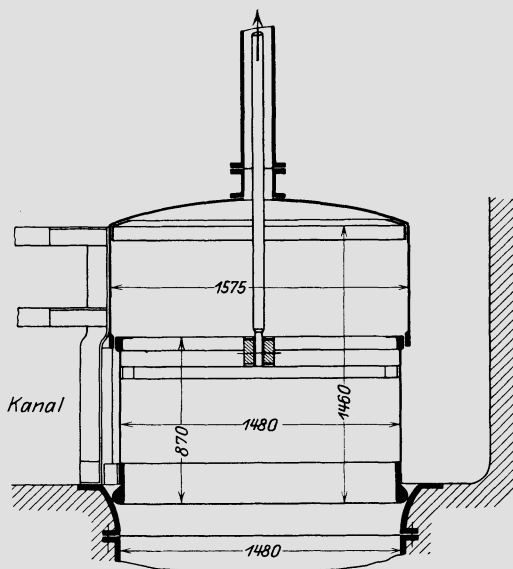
Niederes, geschlossenes Rohrschütz der Schleuse bei Brieg im offenen Schacht. Maßstab 1:40.
